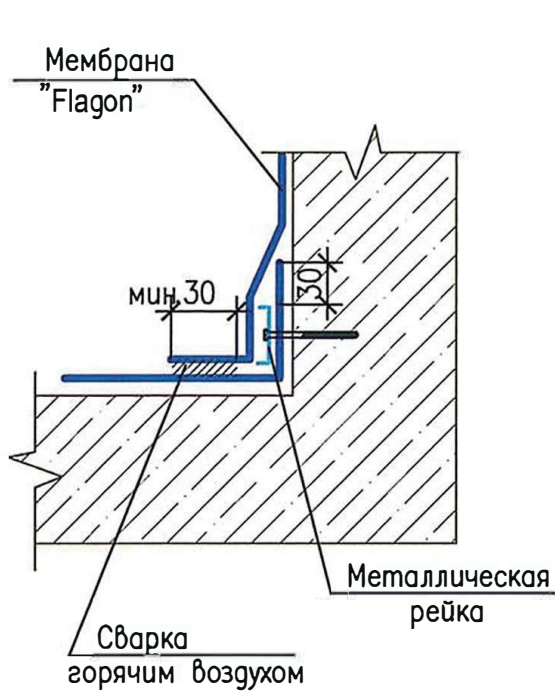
Механическое закрепление к железобетонному основанию. Варианты крепления мембраны в местах примыкания
